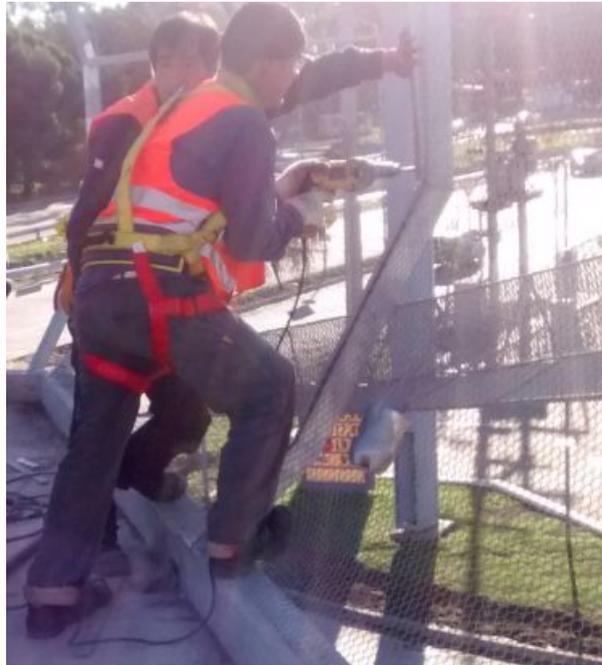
Colocación de planchuelas con tornillos autopercorables.
